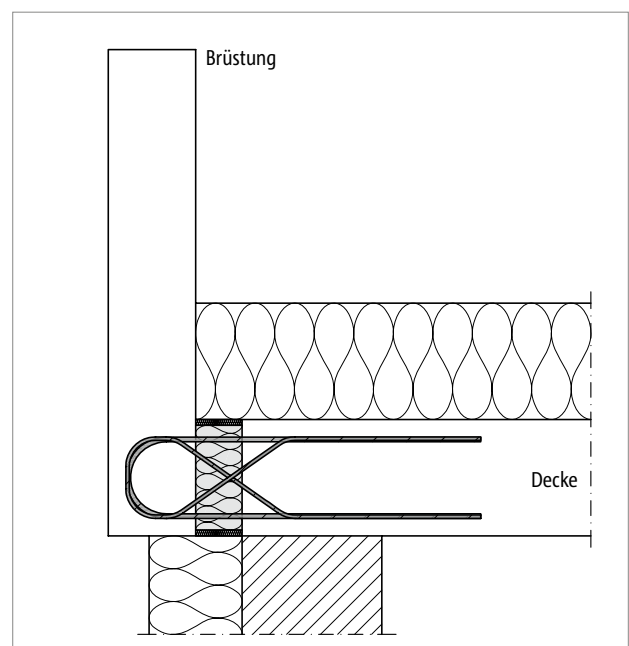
Schöck Isokorb® T Typ AP horizontale Anordnung: Anschluss einer vorgesetzten Brüstung
